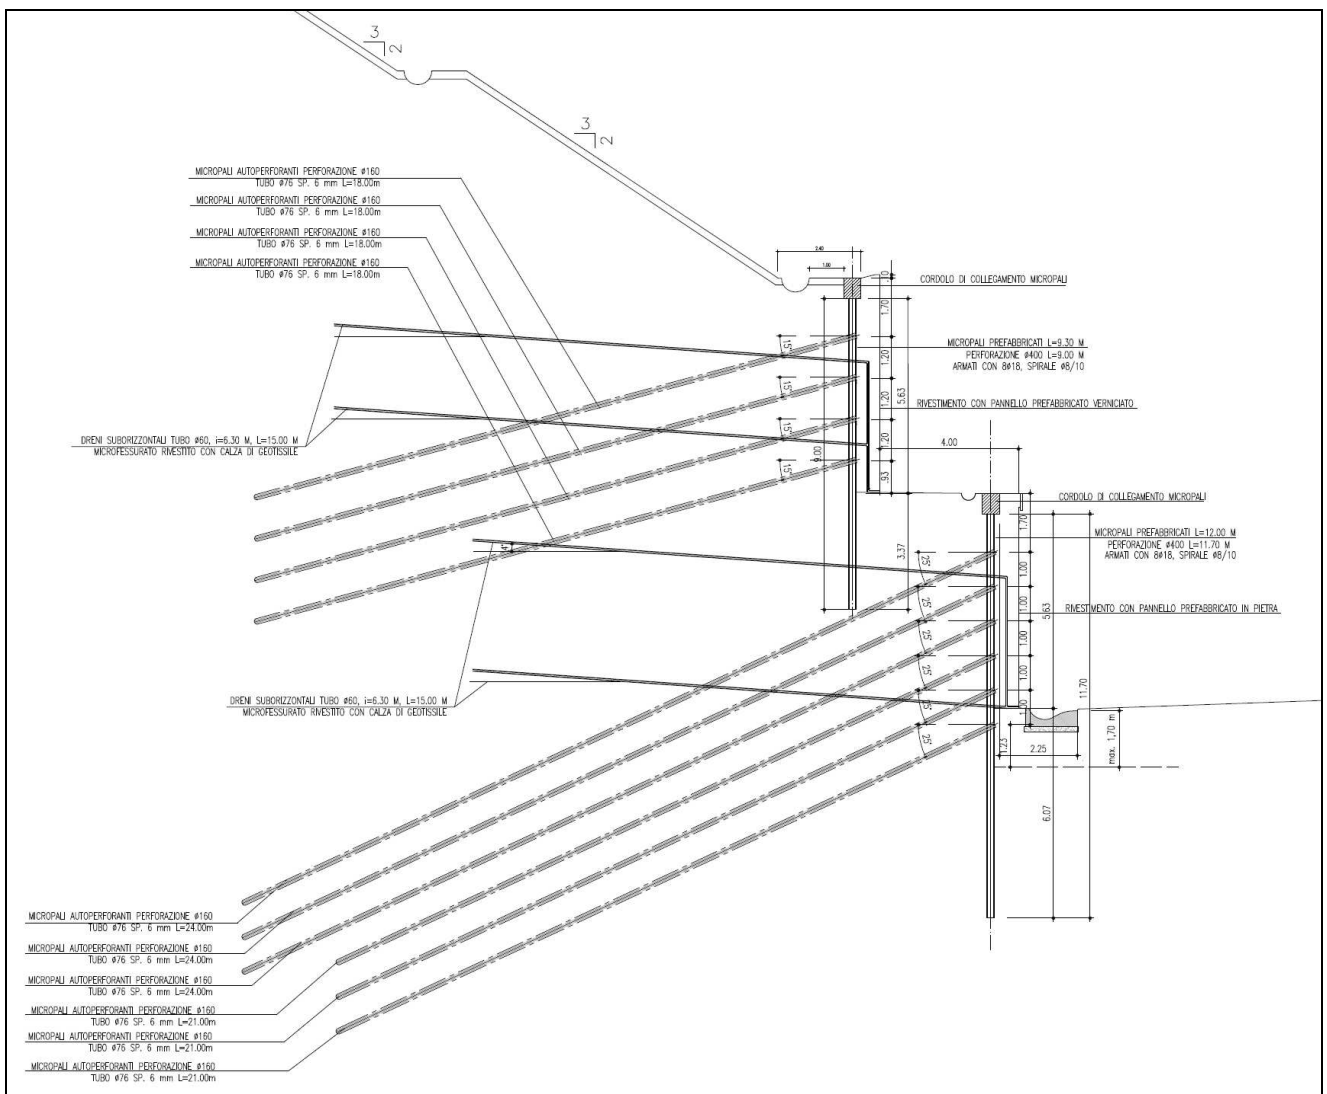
Sezione tipo “Nuova Galleria 3” su carreggiata nord – Proposta di Variante
